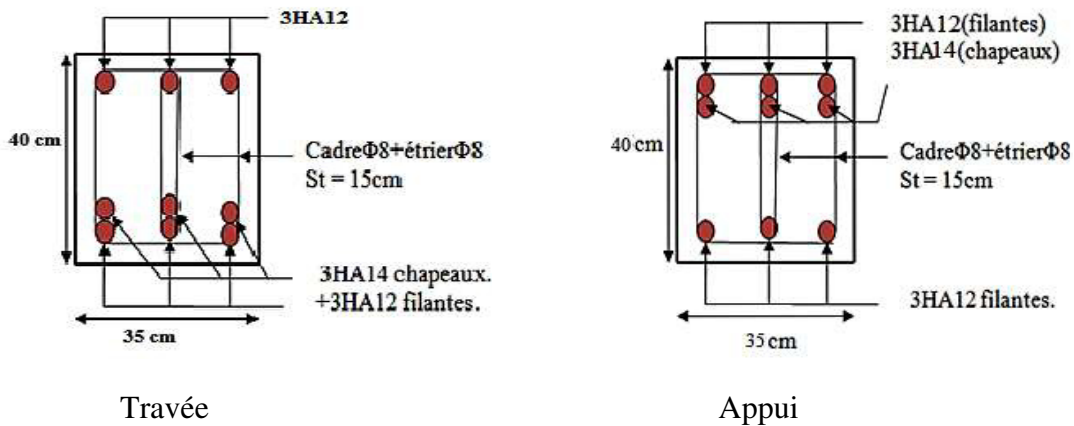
Schéma de ferrailage des poutres principales de RDC - 7 étages.
